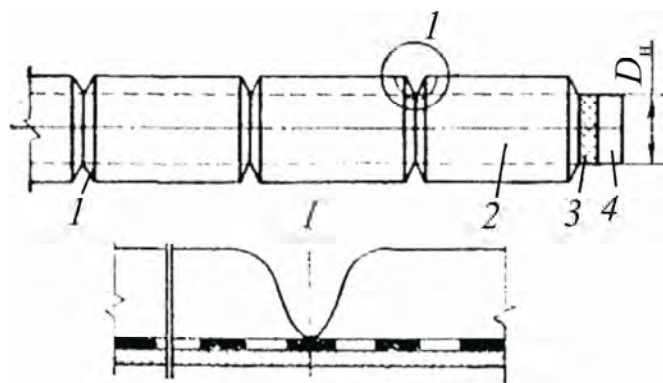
Общий вид трубопровода с монолитным бетонным покрытием: 1 — рабочий шов бетонирования; 2 — железобетонное покрытие; 3 — изоляция; 4 — трубопровод
